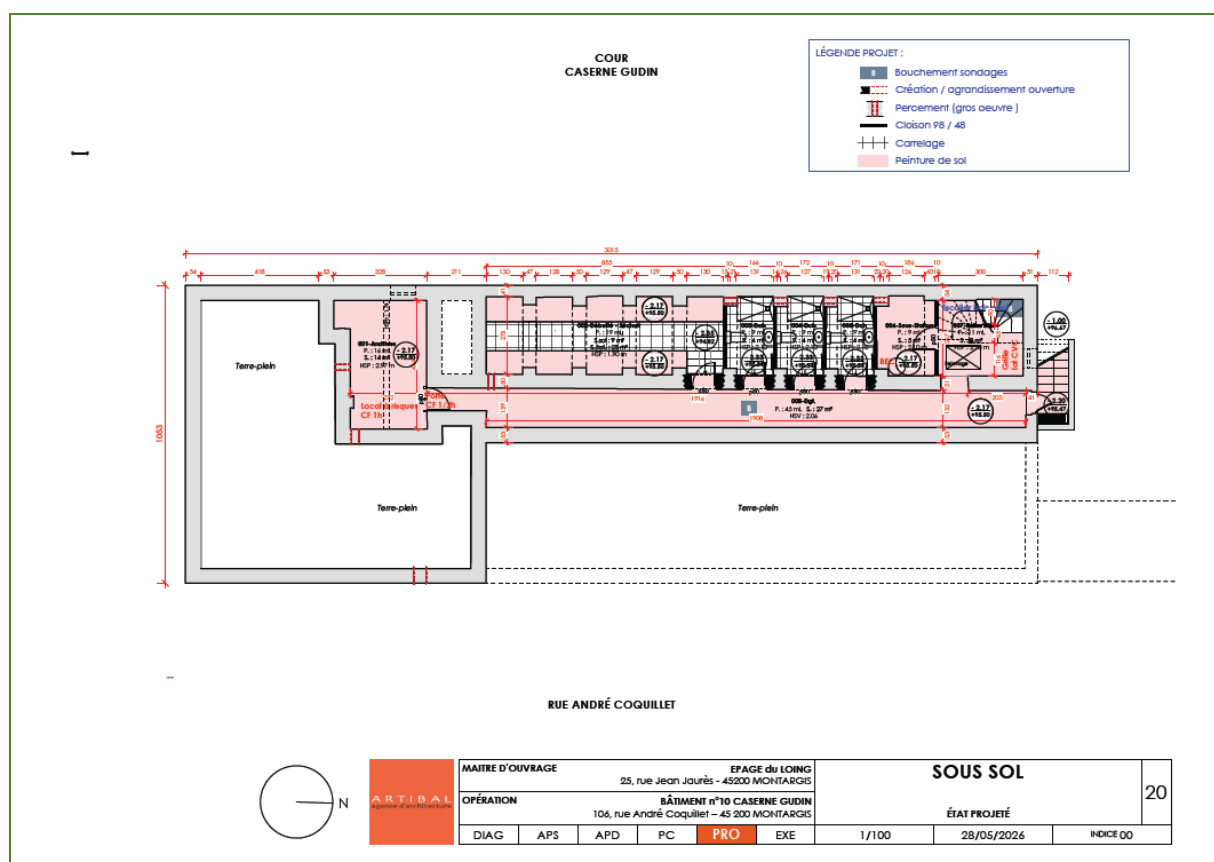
Extrait du plan de Sous-sol du projet [2]
